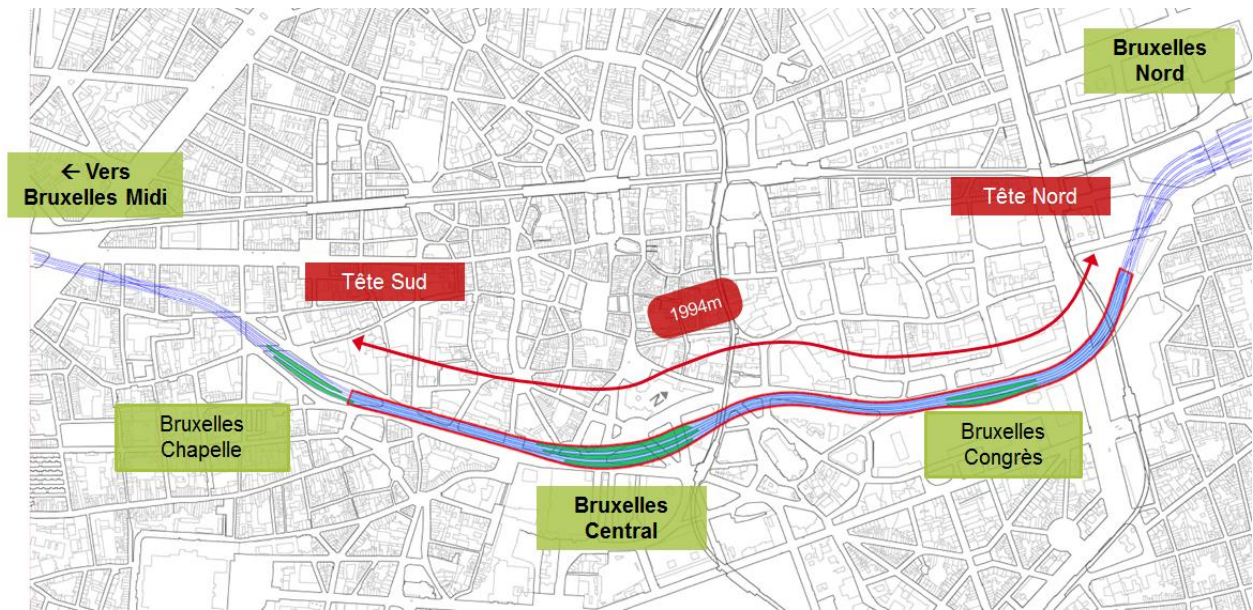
vue en plan du tunnel de la jonction Nord-Midi
